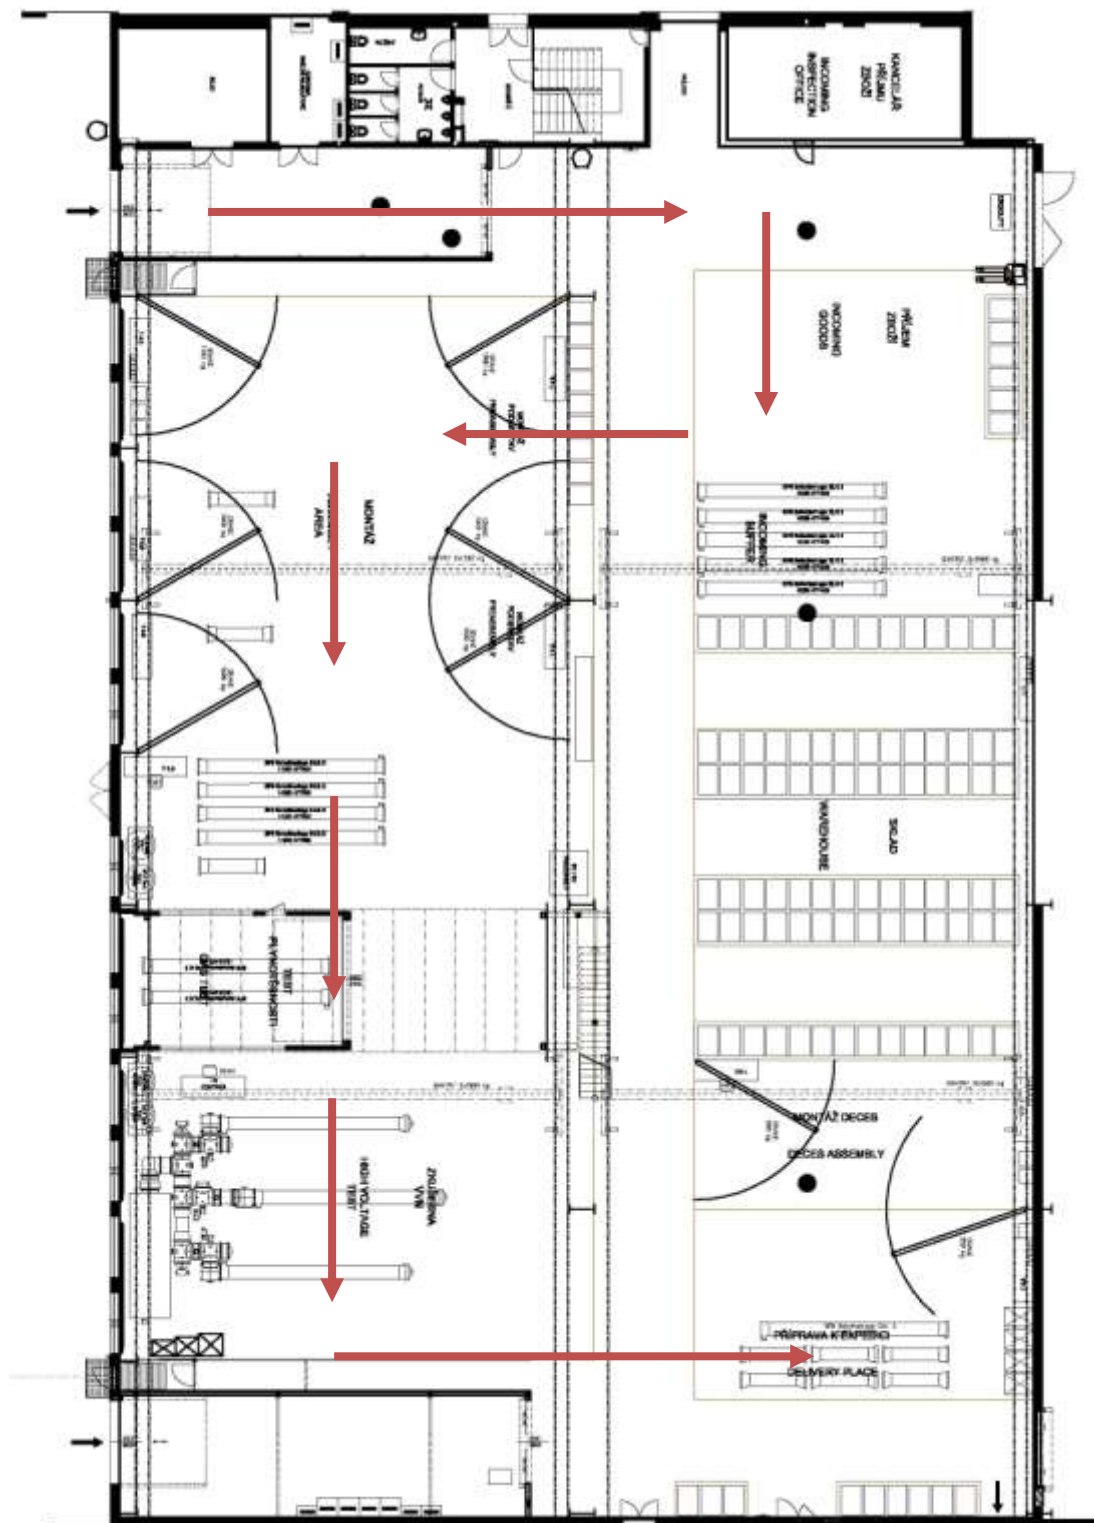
Layout výrobního areálu – toky materiálu (vlastní zpracování)
